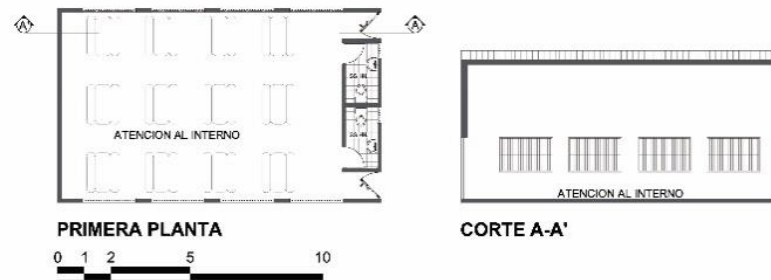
Plantas y corte del venustorio de la zona A
